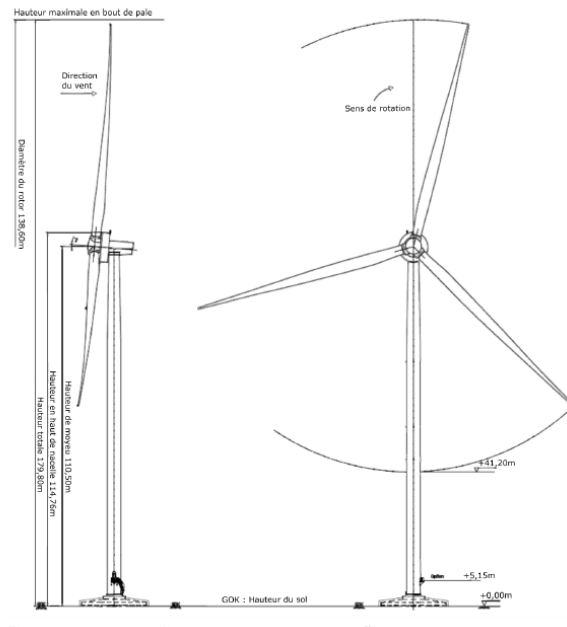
plan d'élevation de l'éolienne ENERCON E-138-EP3
